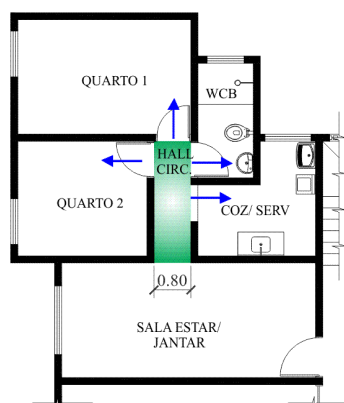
Planta Baixa Pav. Tipo: Hall de Circulação do Residencial Germano Santos (sem escala)
